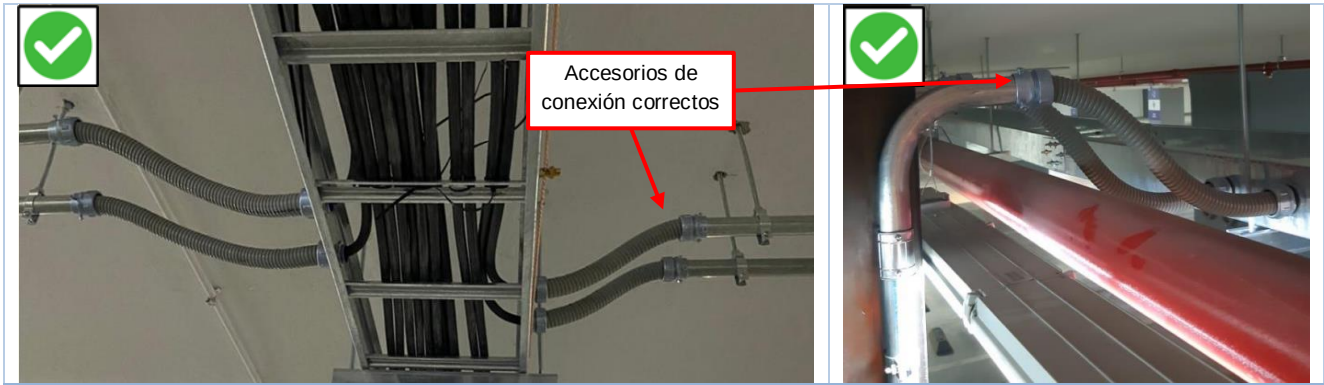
Buenas prácticas en tuberías metálicas flexibles.
